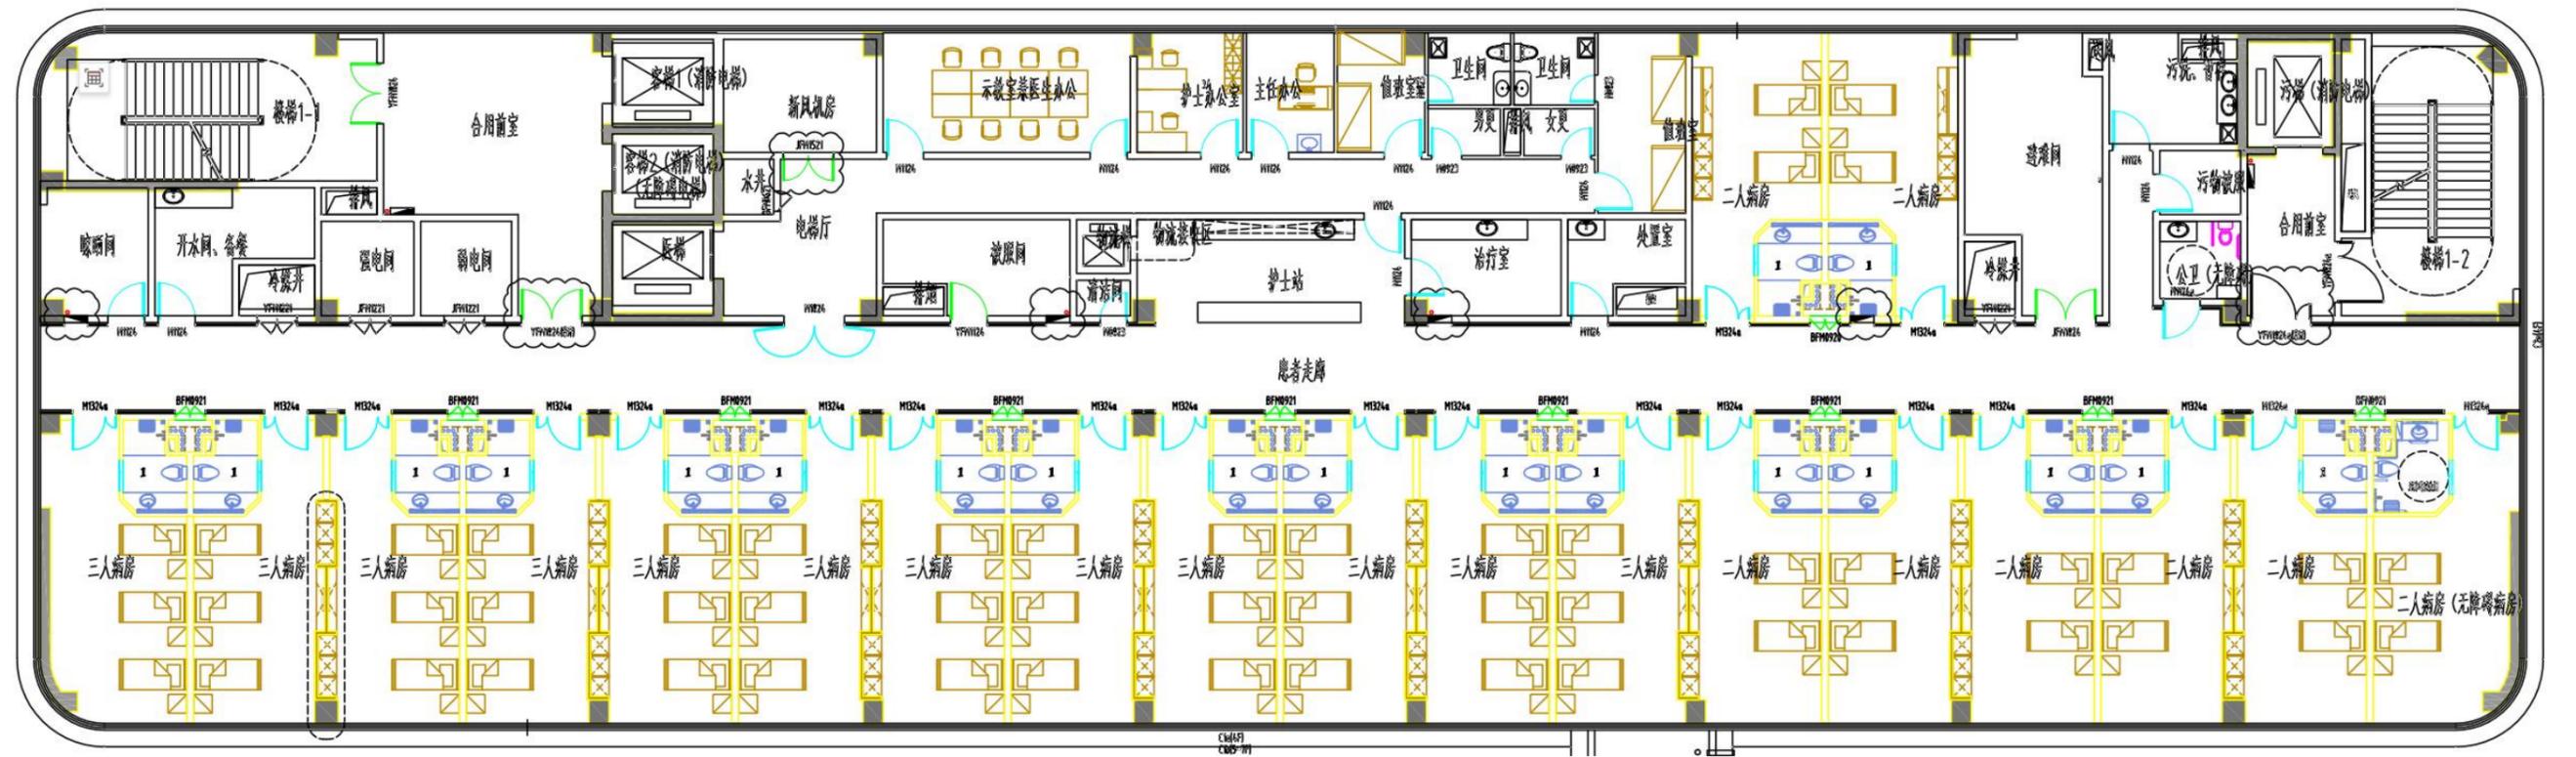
1#普通病房楼四~七层平面布置示意图
